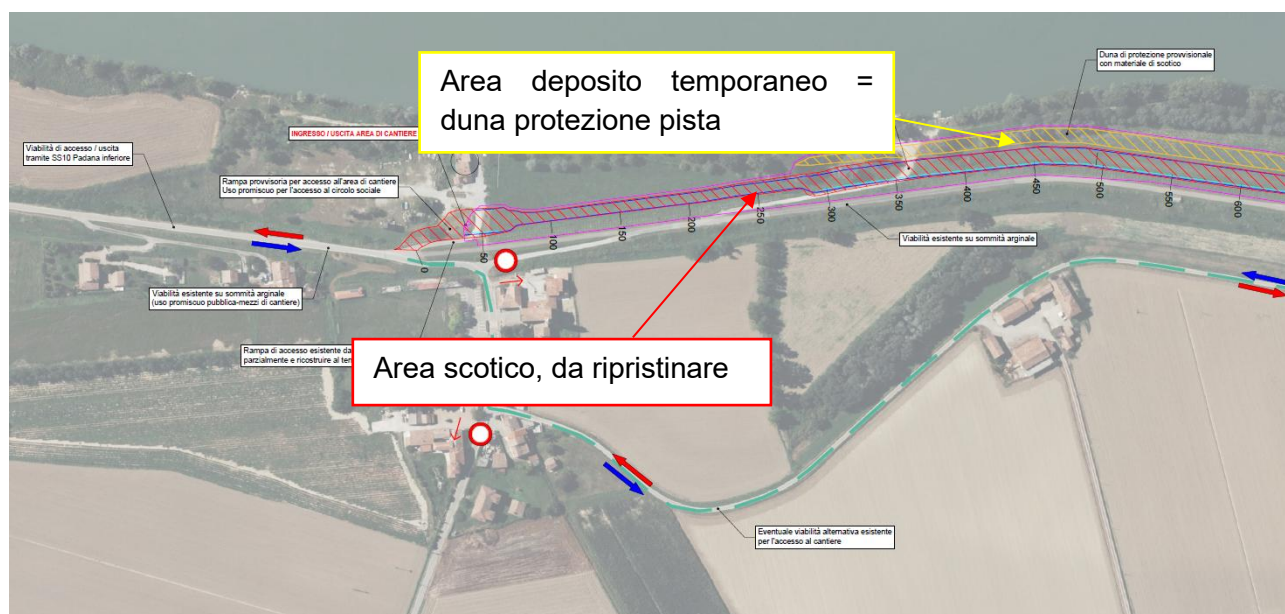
Estratto dalla tavola PE.0.1.6.SIC.GE.P.L.0.0.1 “Layout di cantiere” – area sud Caorso.
